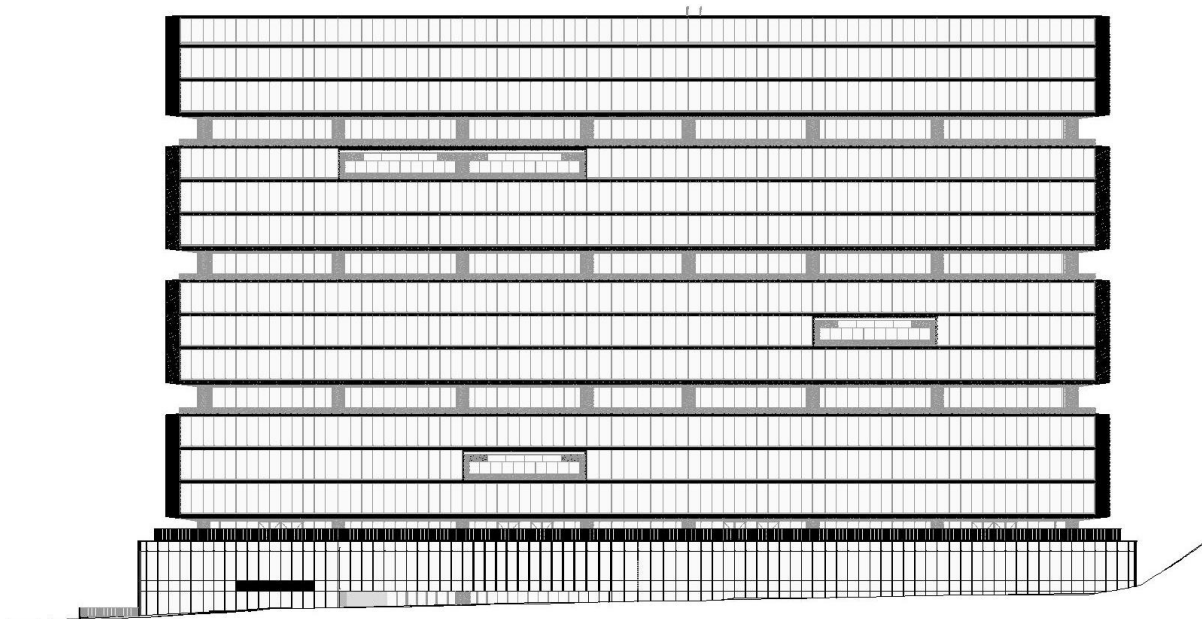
Fachada A / Frente (lateral Oeste) do Edifício Lótus Tower.
